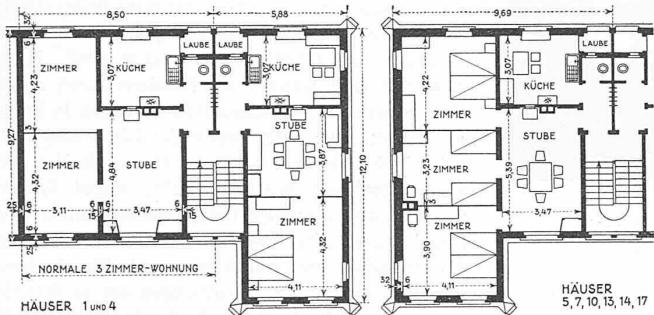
Grundrisstypen im Eismannhof. — 1 : 300.
